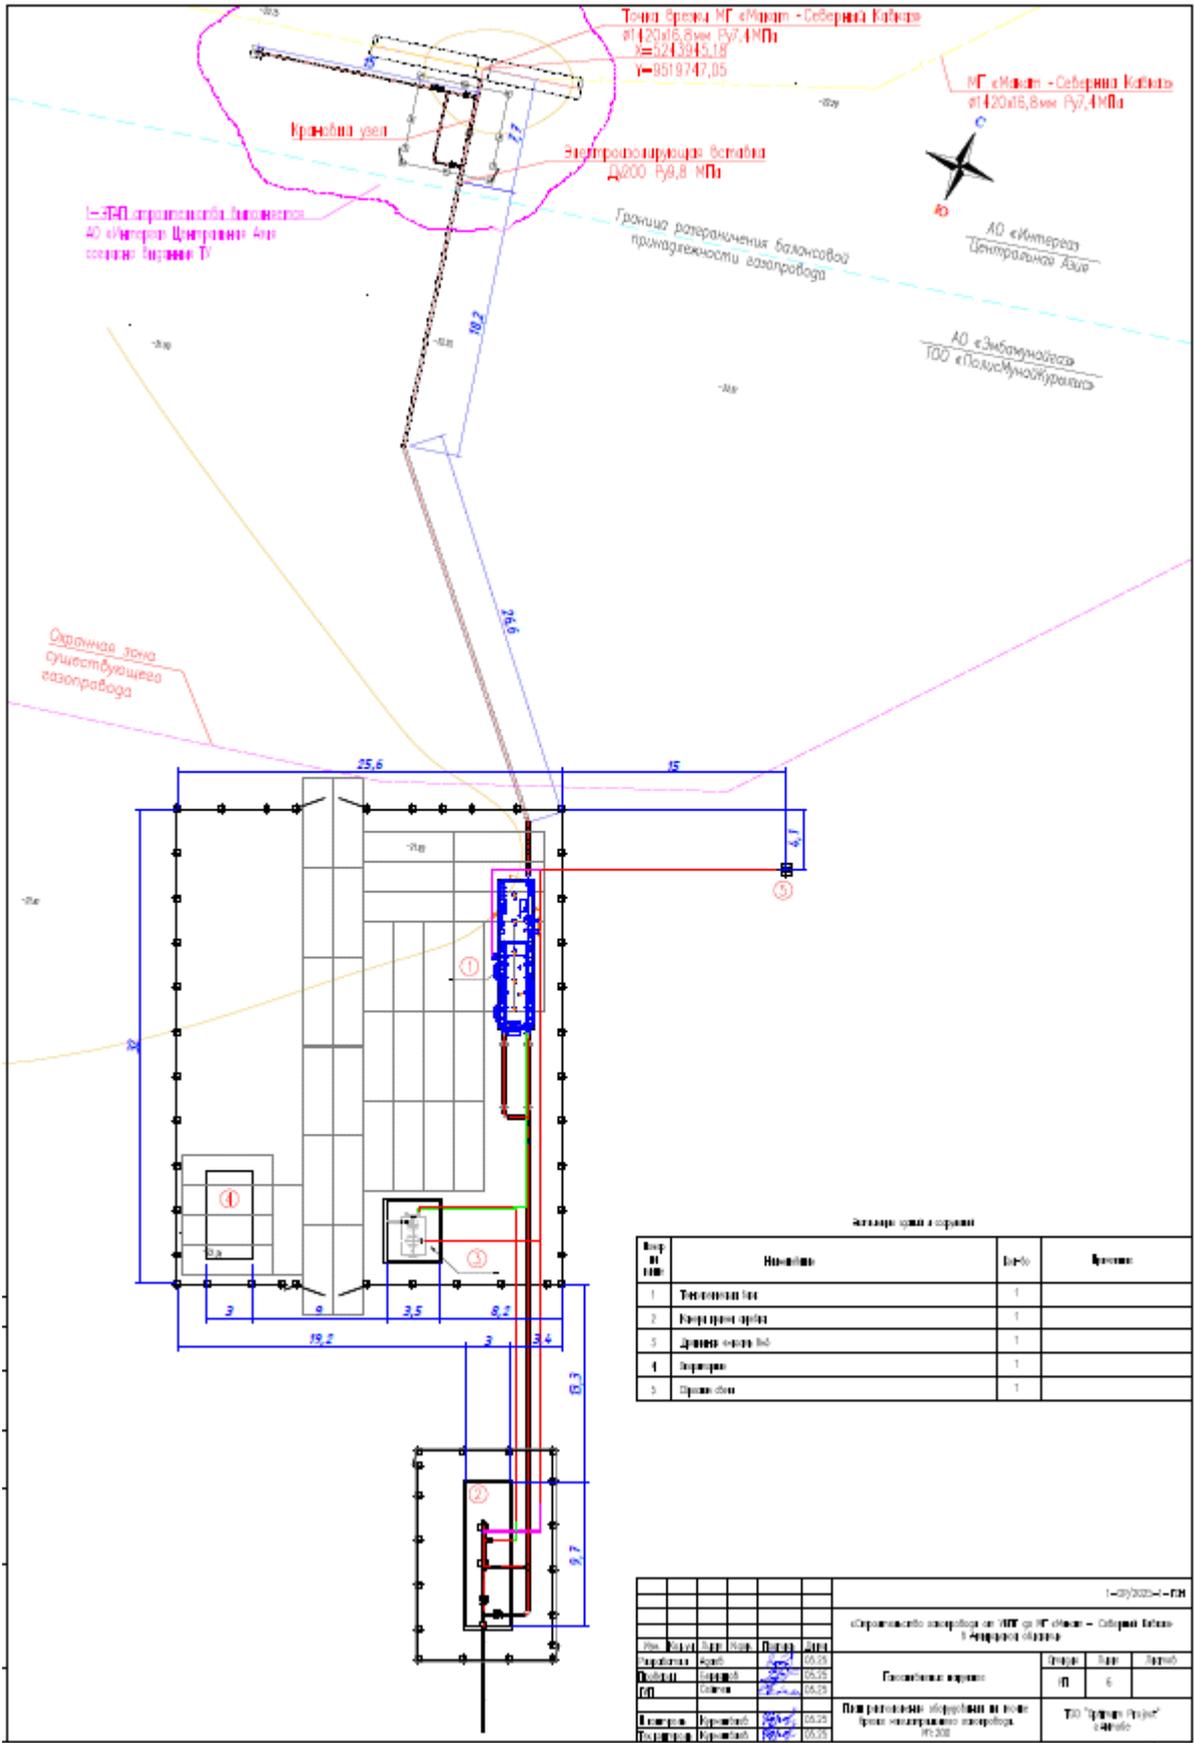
Генеральный план прохождения газопровода и площадок
